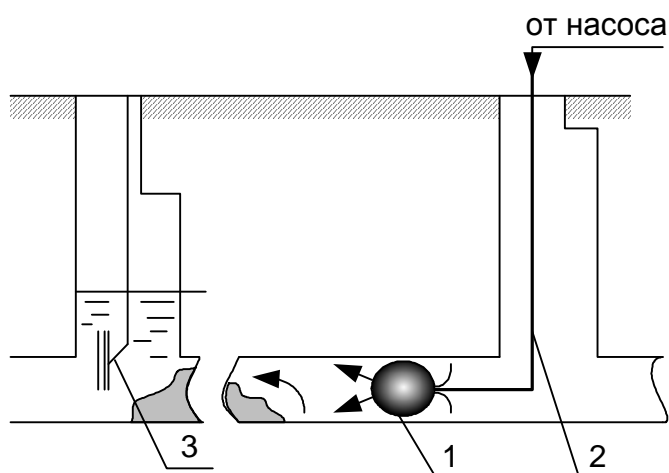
Схема гидродинамической промывки: 1 – реактивный насадок; 2 – шланг; 3 – пробка
